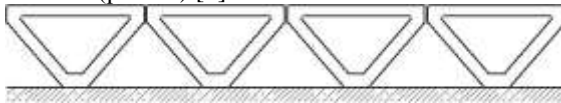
Поперечний переріз перекриття зі збірних плит пустотілого трикутного профілю
